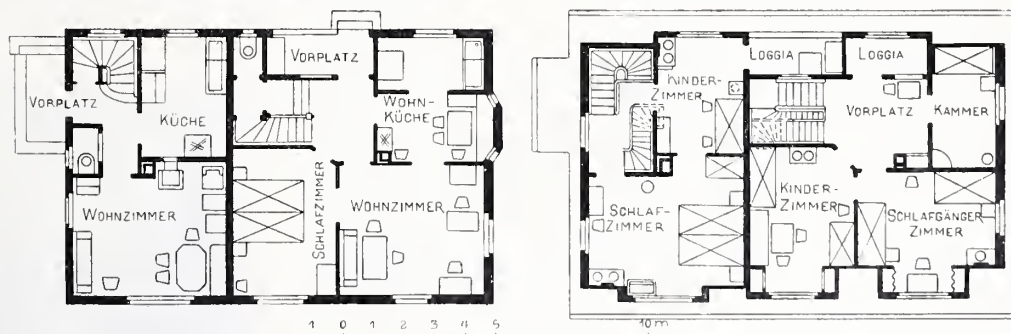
Grundrisse zu Erdgeschoss und Dachstock des Zweifamilienwohnhauses (Abb. 4). — 1 : 250.
